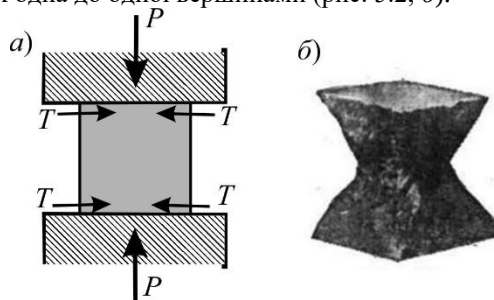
Випробування кубів бетону: *a* – силова схема, *б* – зруйнований зразок
